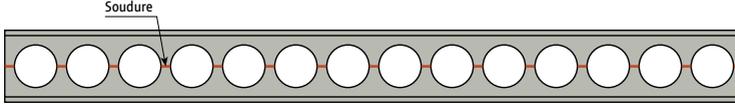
Fabrication d'une poutre cellulaire à ouvertures circulaires
